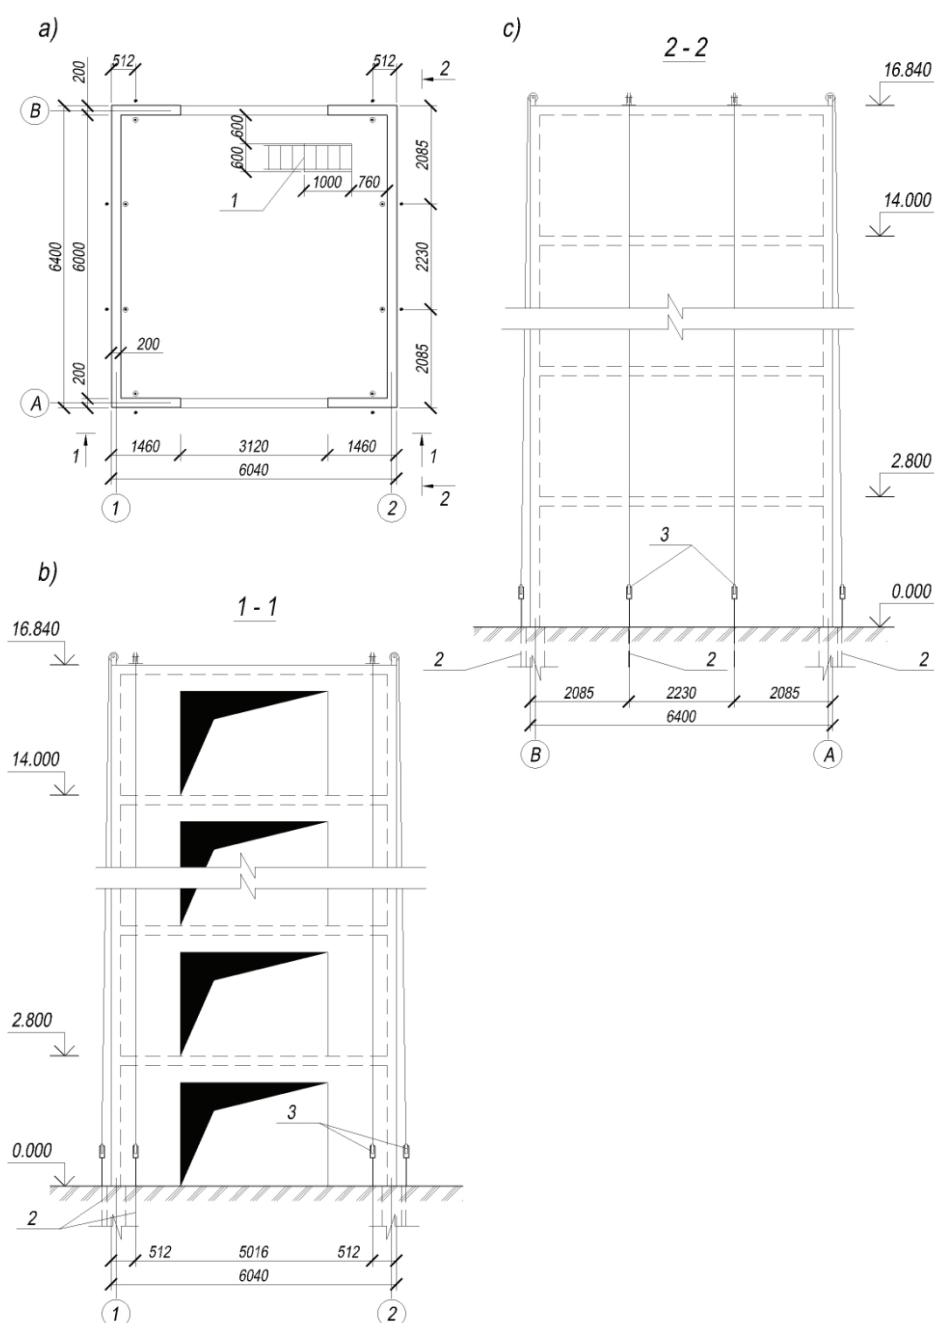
План (а) и фасады (b, с) фрагмента: 1 – проем в перекрытии для лестницы; 2 – анкера тросо-блочной системы; 3 – система вертикального обжатия фрагментов
